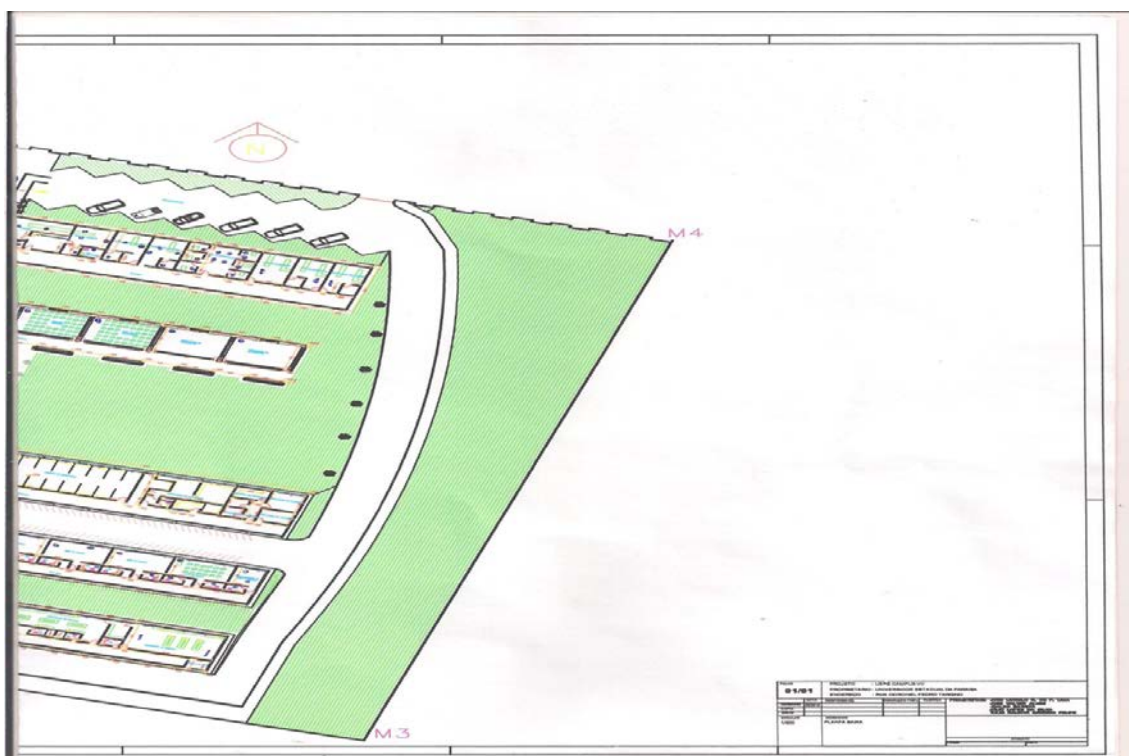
Parte 2 da planta baixa do *Campus VIII*, da UEPB.
